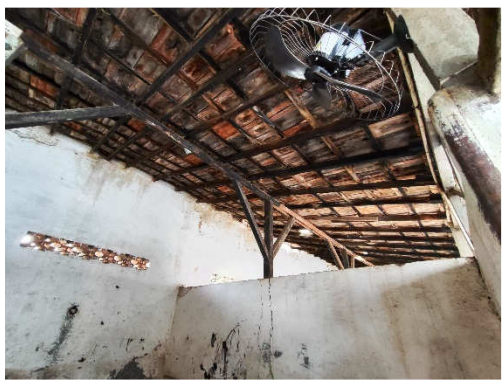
interior do alojamento CB/SD interditado (sem laje, só forro)	Foto 005 – Telhado do alojamento Cb/SD
